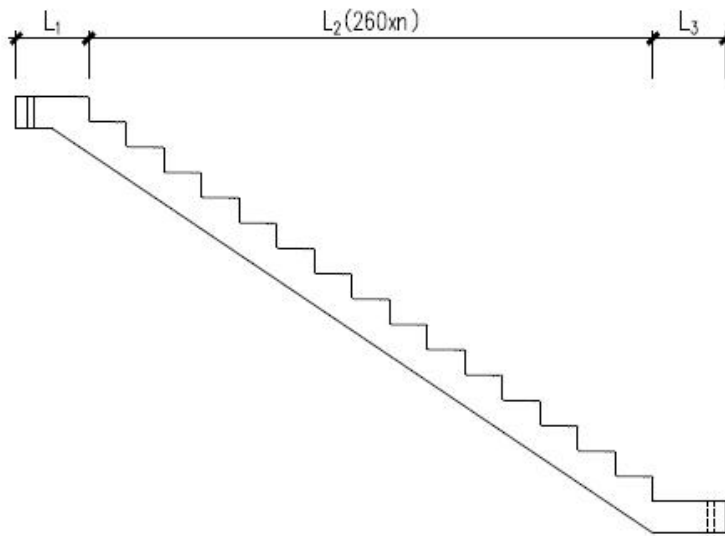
剪刀梯 (JT) 剖面示意图
